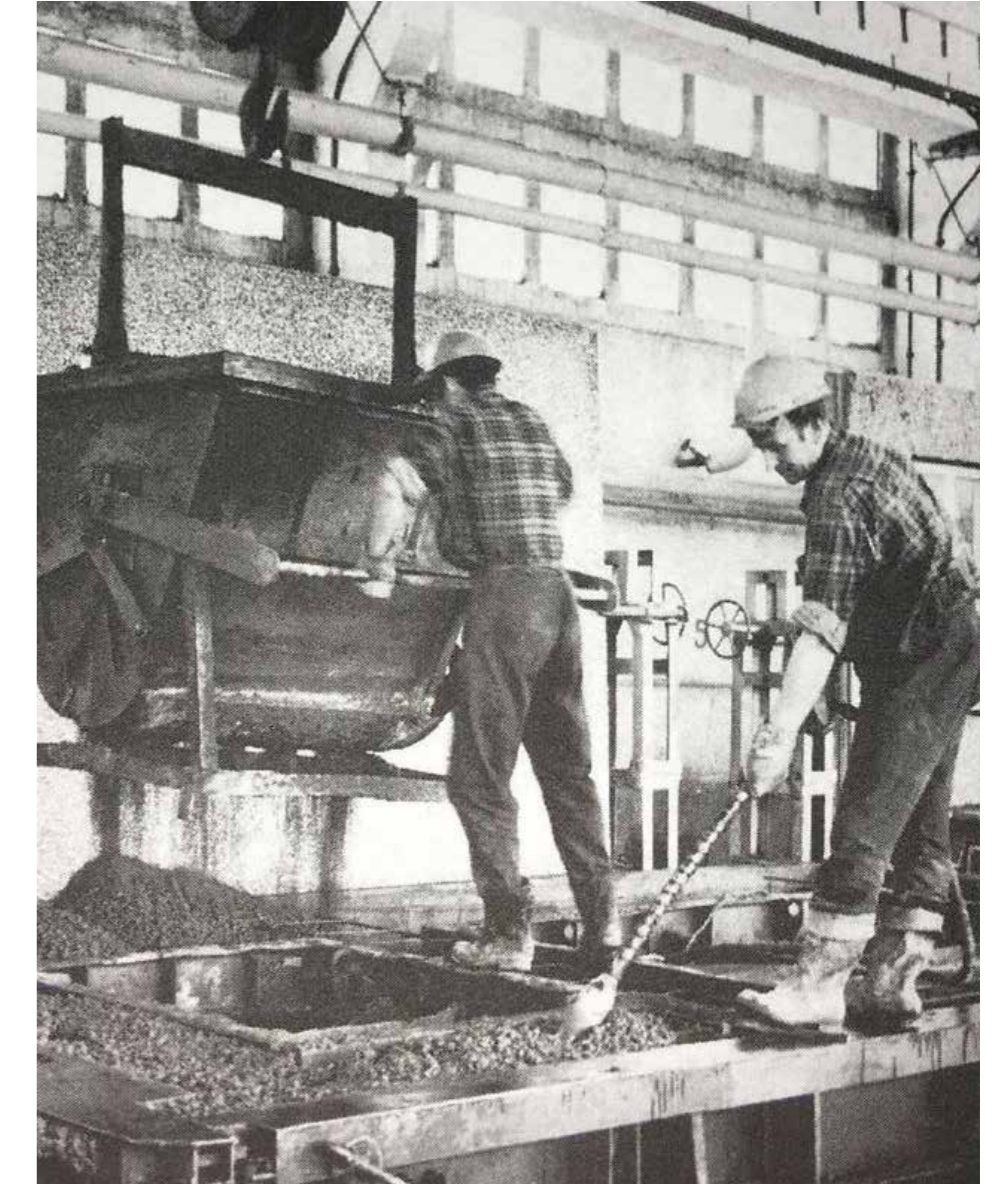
Trabajadores Hciendo la mezcla para del Hormigón
